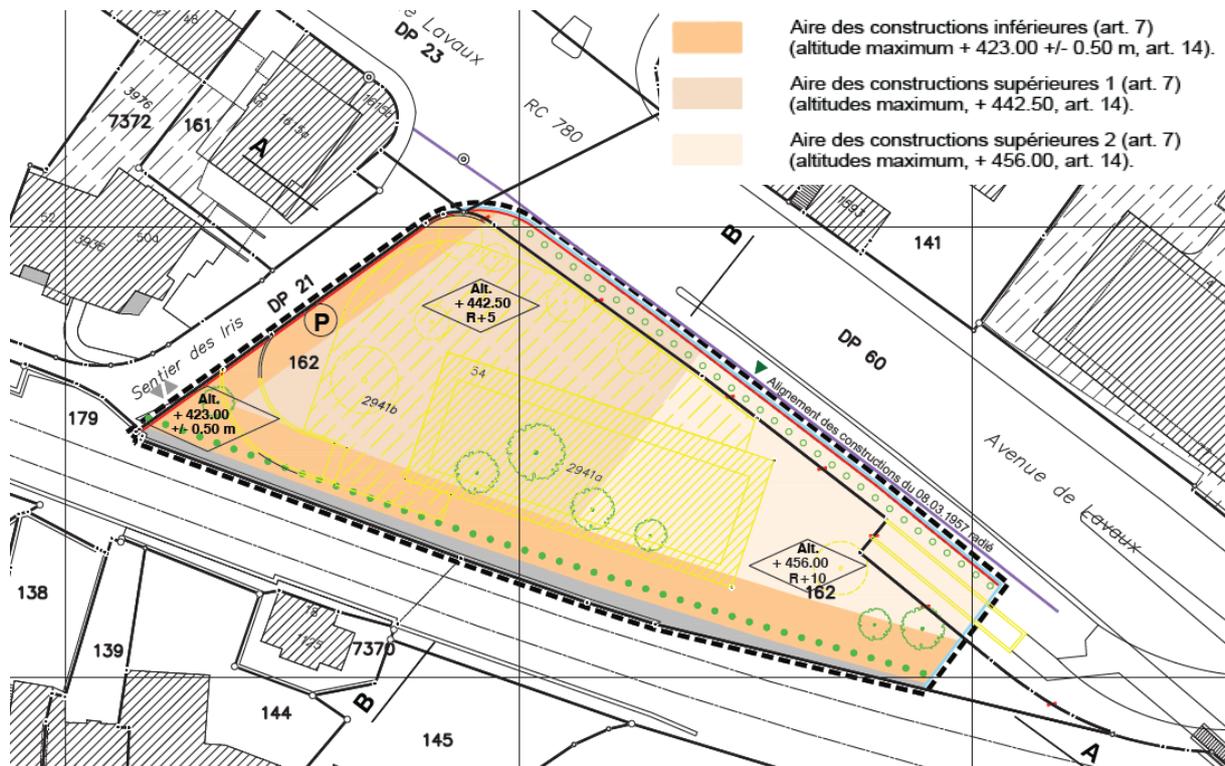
plan de détail du PA « Claire-Fontaine II » - @Ville de Pully
